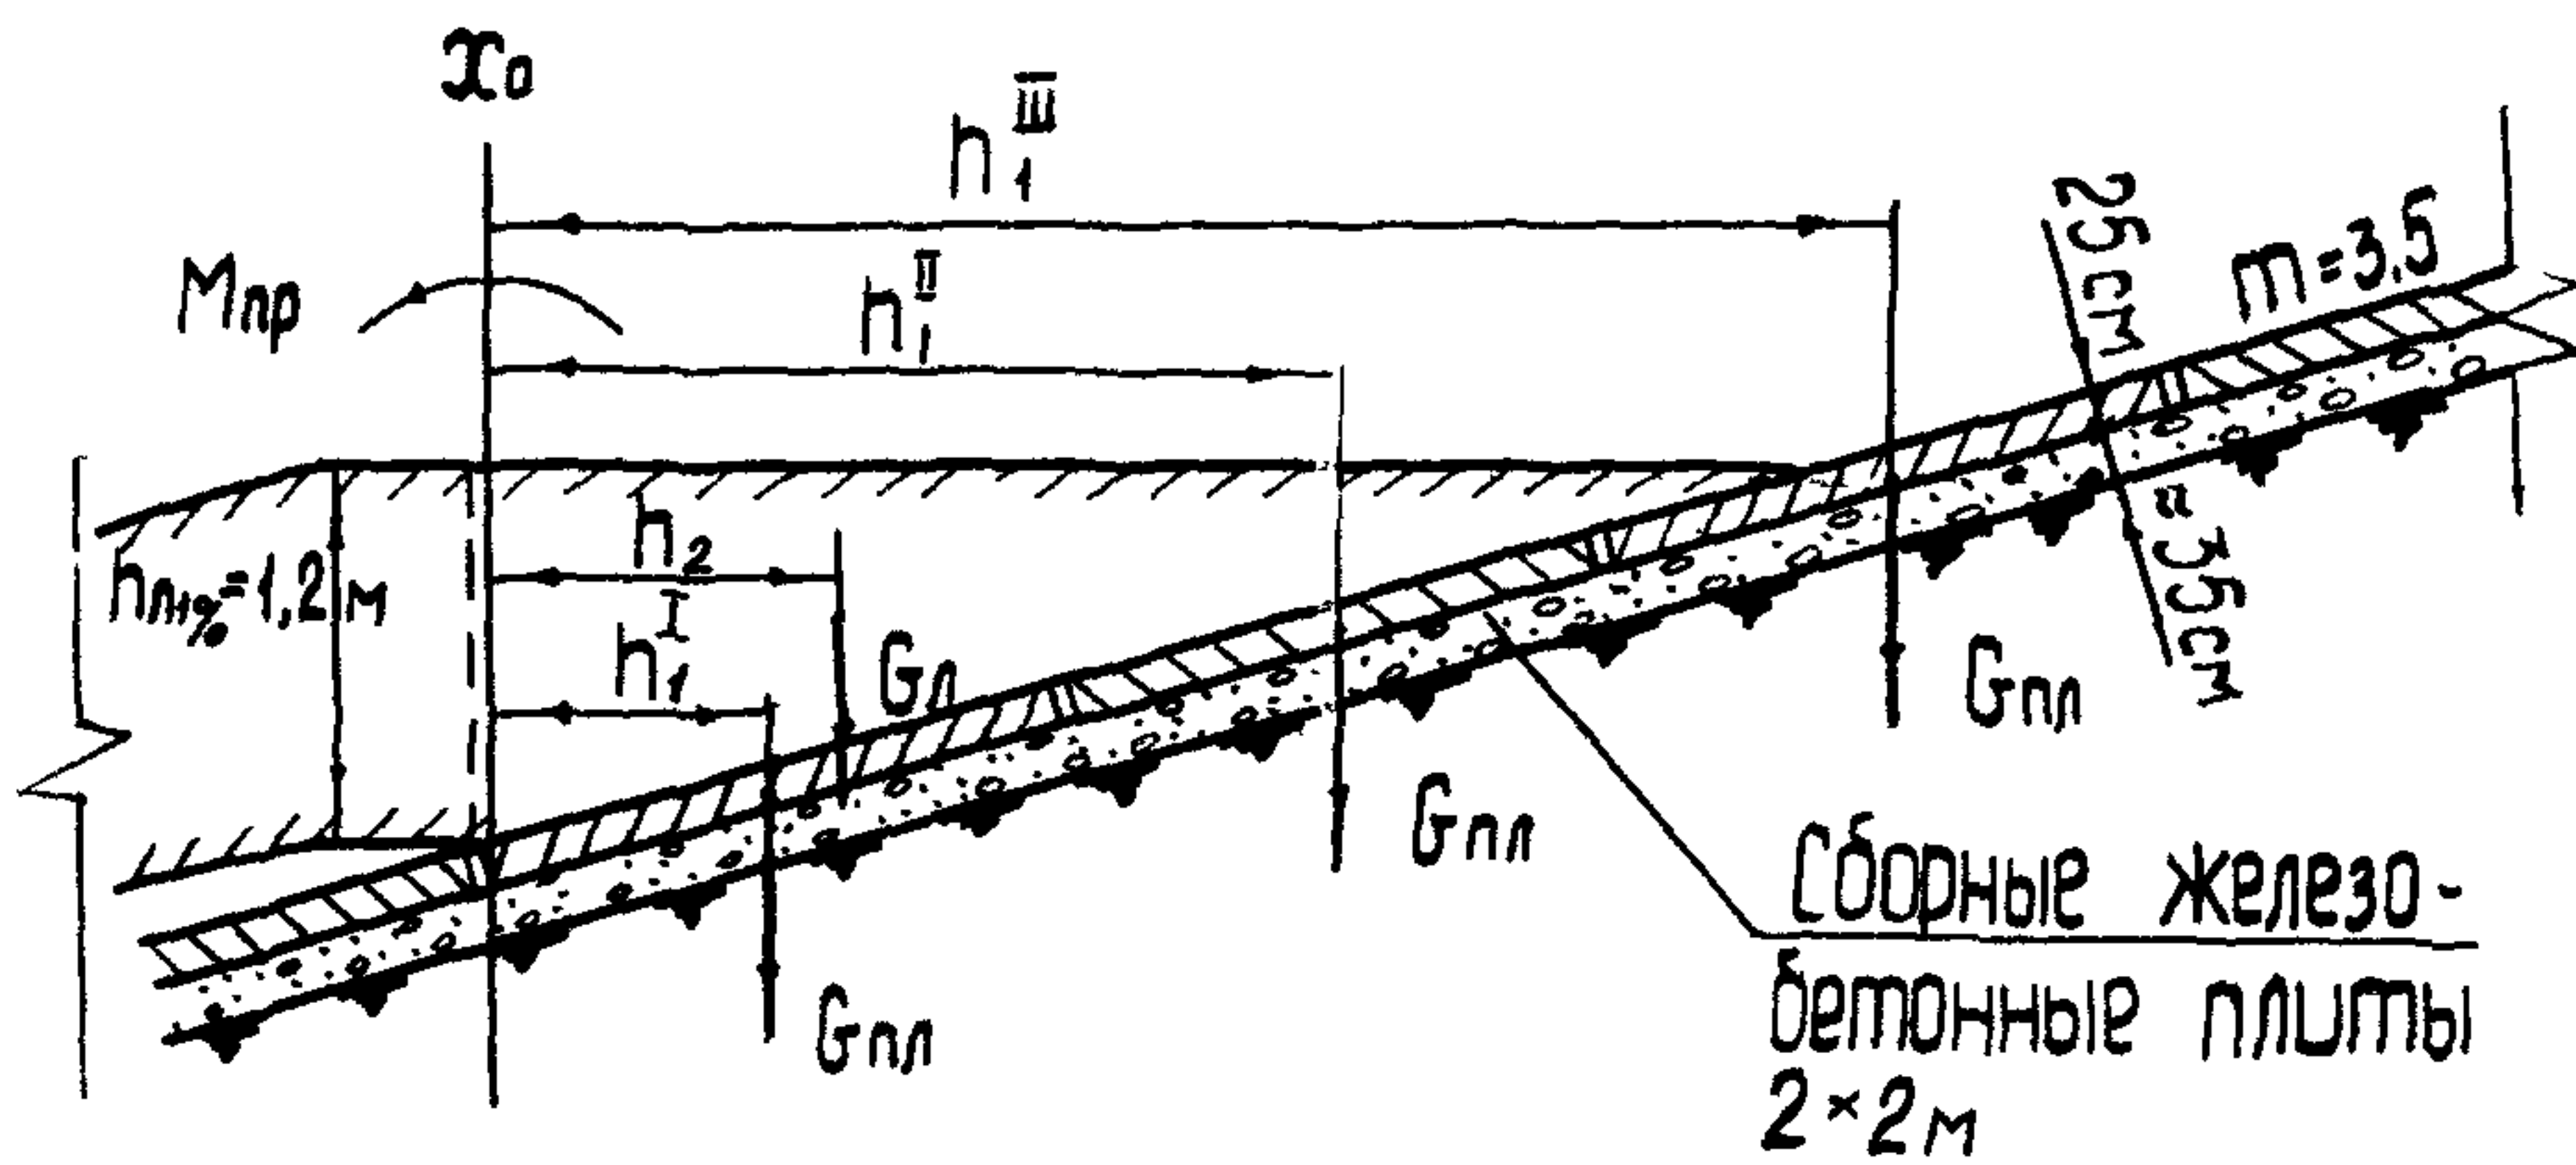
Схема сил и расчету на устойчивость сборного крепления при вырывающей ледовой нагрузке.
